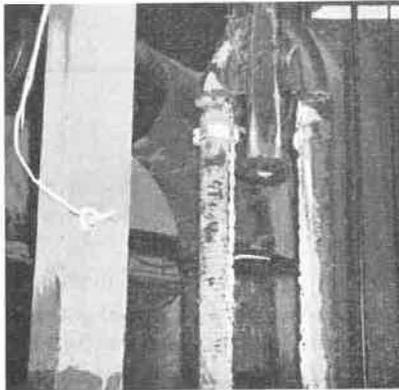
Partie terminale de la tuyauterie du bétonnage avec les 2 flexibles amenant le béton en place.
